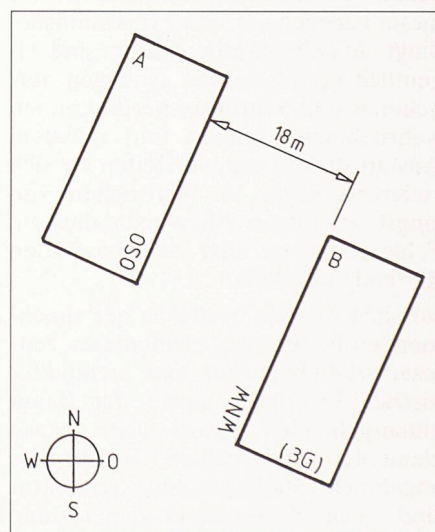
Zwei Gebäude einer Wohnüberbauung genügen der 2-Stunden-Schattenregel vollauf. Sie sind jedoch so ungünstig orientiert, dass ihre Fassaden nicht genügend besonnt werden. (Aus bewilligtem Überbauungsplan mit Spezialbauvorschriften für Oftringen.)
